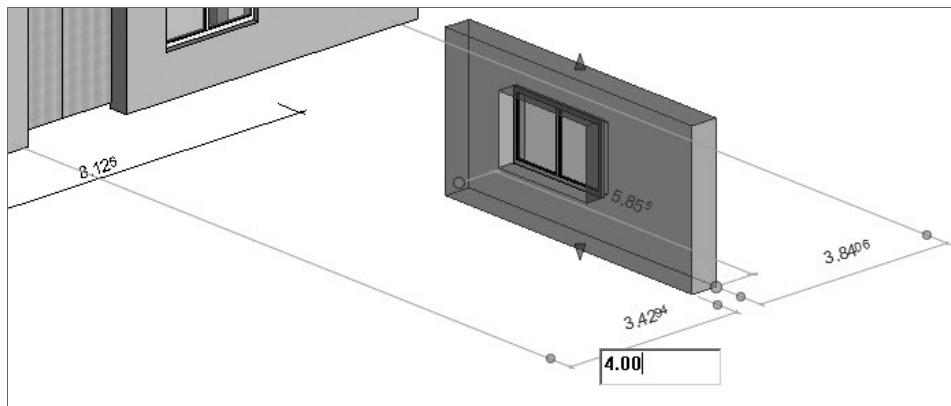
Griffe und Bemaßungen zum Ändern einer Wand
